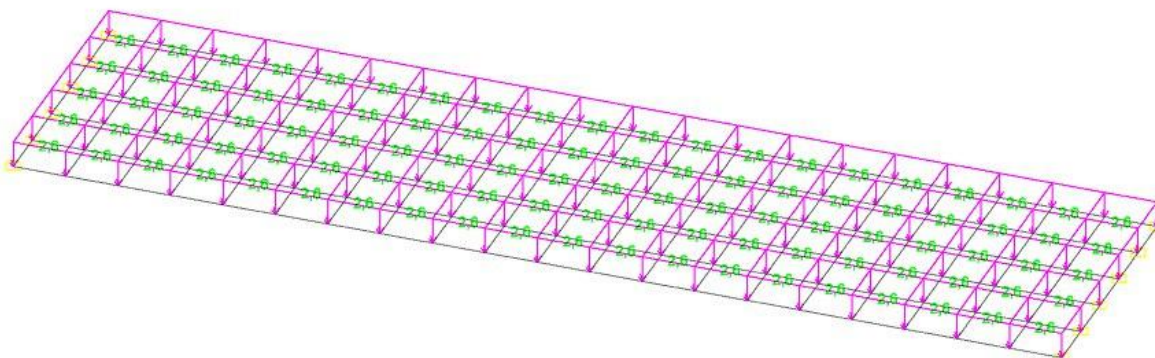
Схема загрузки плиты полной расчетной нагрузкой
